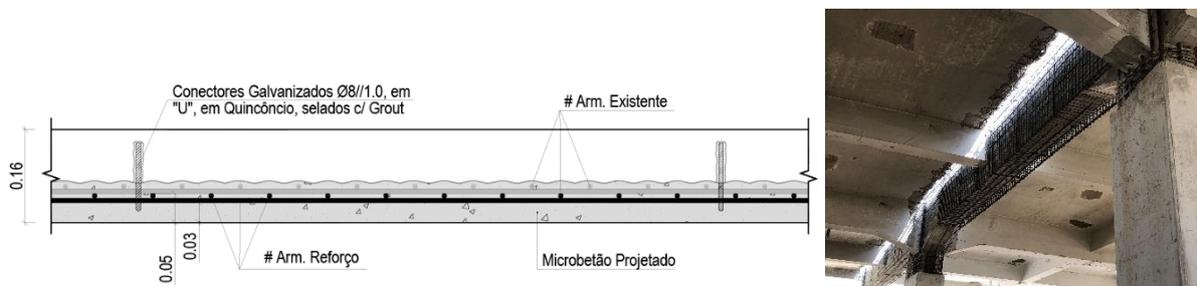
Reforço das lajes existentes (Corpo A). Reforço de Vigas por encamisamento.
